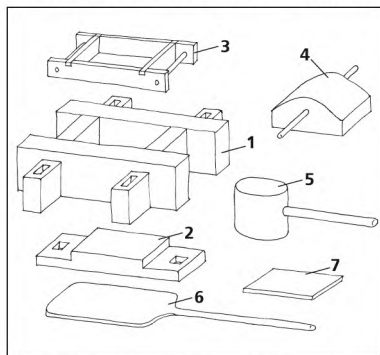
Деревянная форма с принадлежностями для изготовления землебитных камней. 1 - форма, 2 - дно формы, 3 - рамка или добавок, 4 - болванка, 5 - колотушка, 6 - лопата, 7 - дощечка.
